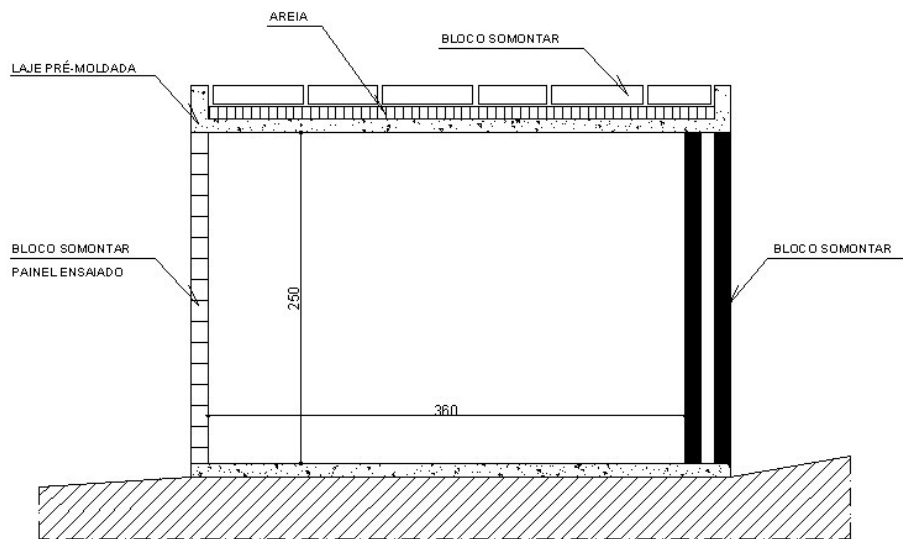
Planta da câmara de ensaio I (unidades em centímetros)
